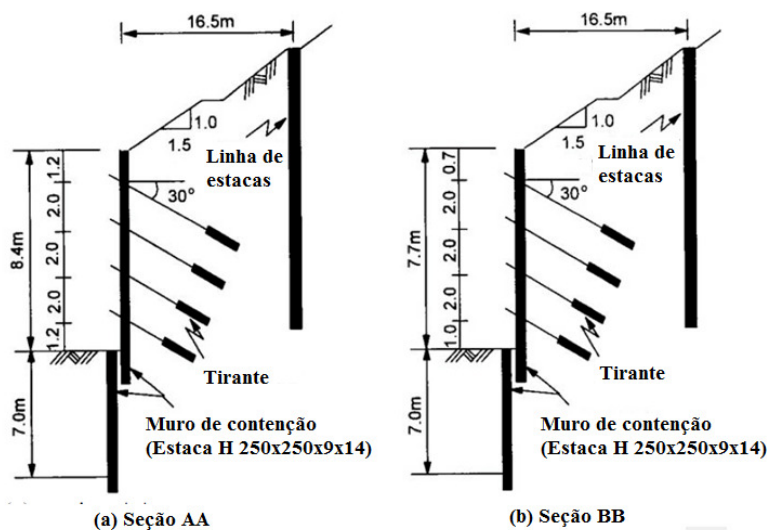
Cortinas atirantadas instaladas no corte do talude (Song et al., 2006).
